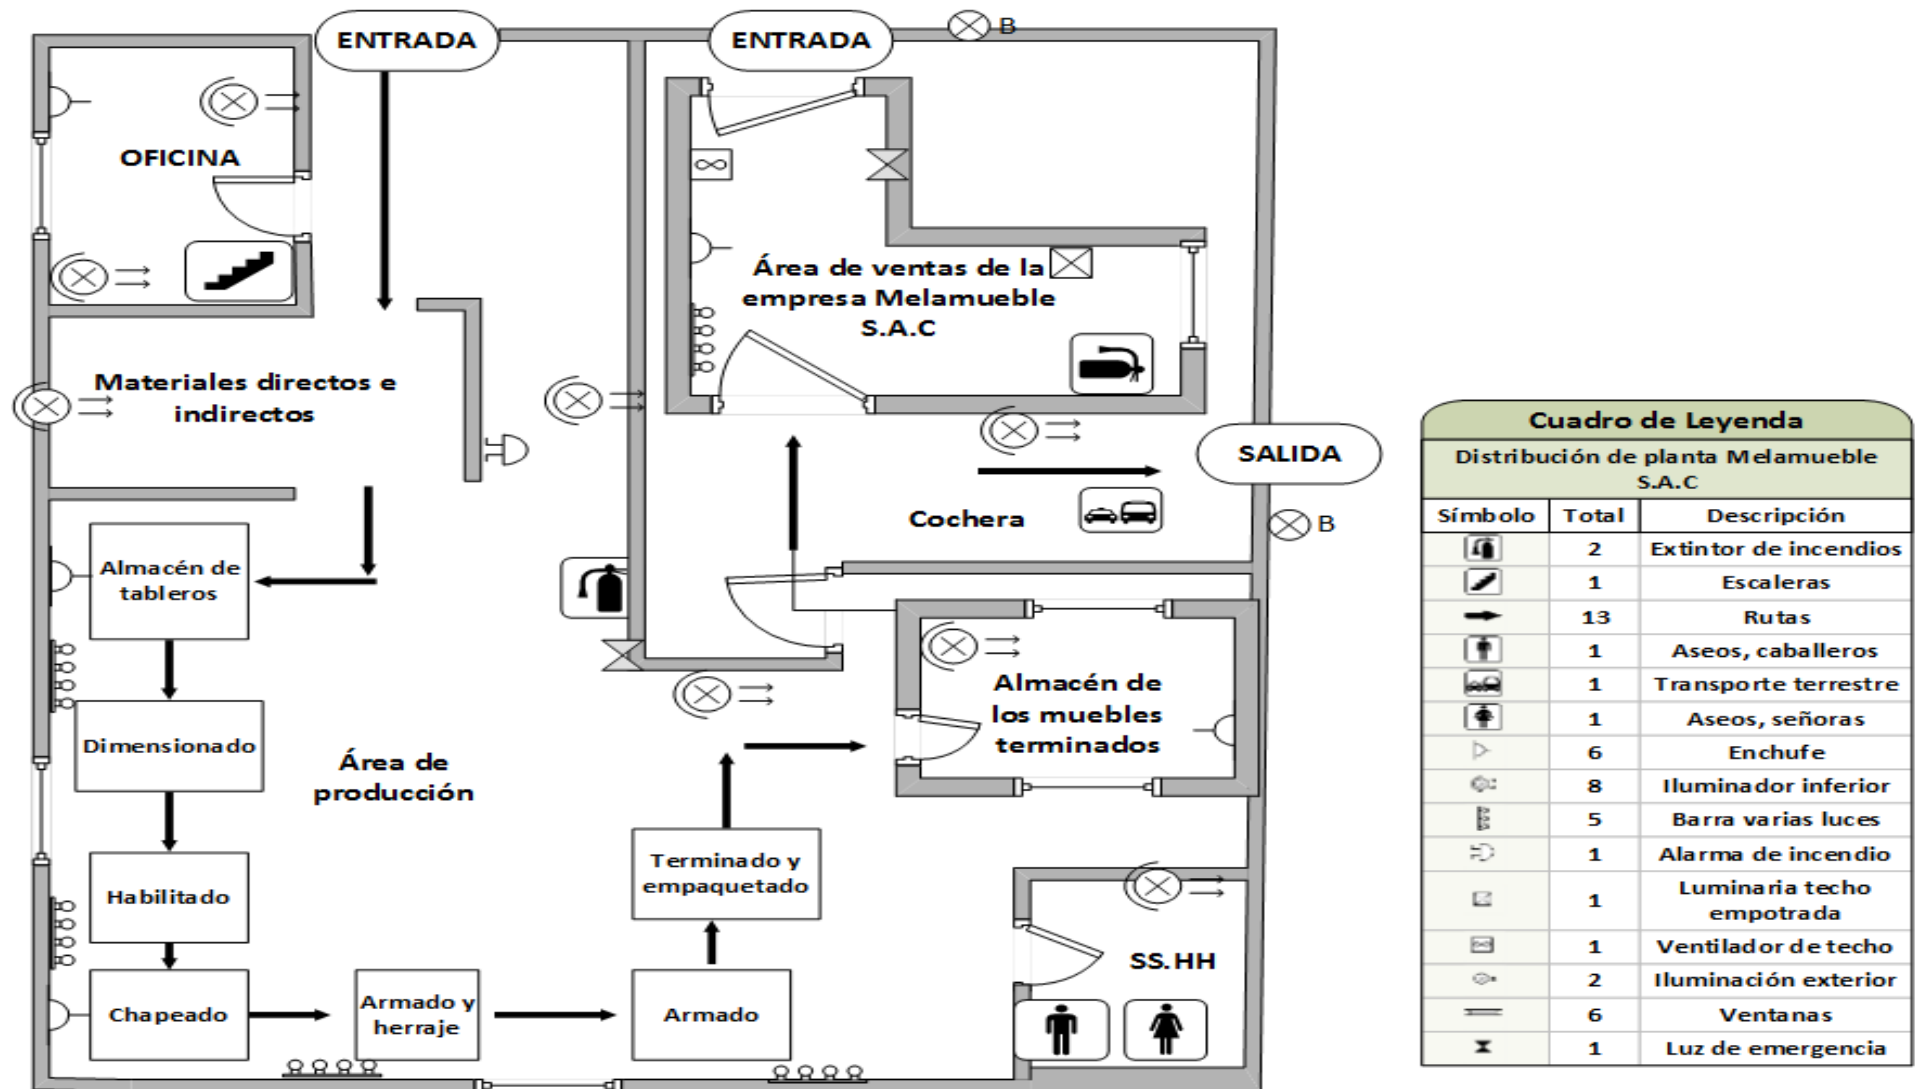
Distribución de planta de la empresa Melamueble S.A.C
